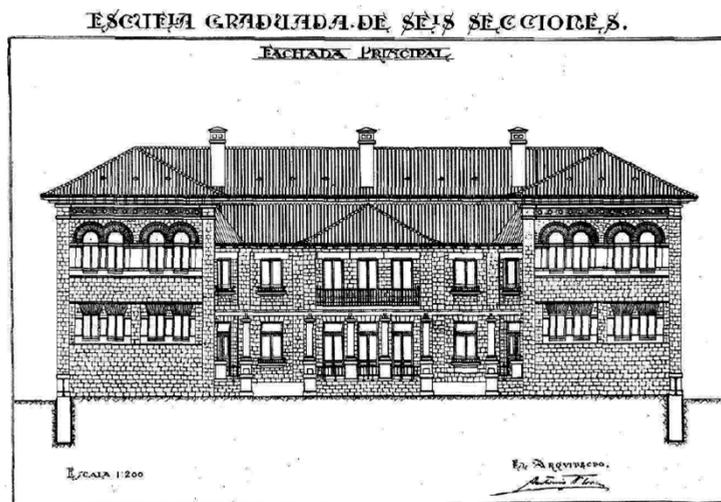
Esquema trazado por Antonio Flórez en el Plan de Construcción de escuelas encargado por el Ministerio de Instrucción Pública. Fuente: Fomento de Construcción de Escuelas Nacionales. Instrucciones para la tramitación y concesión de préstamos a los Ayuntamientos, Madrid, 1924.
